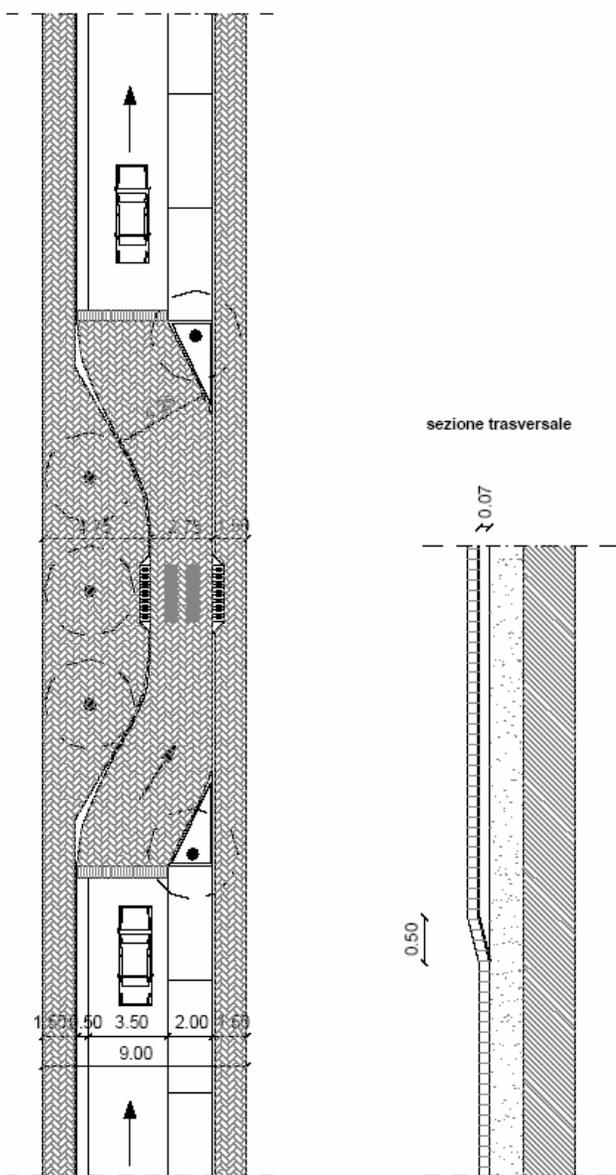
Moderazione Traffico – Tratto stradale pavimentato rialzato
